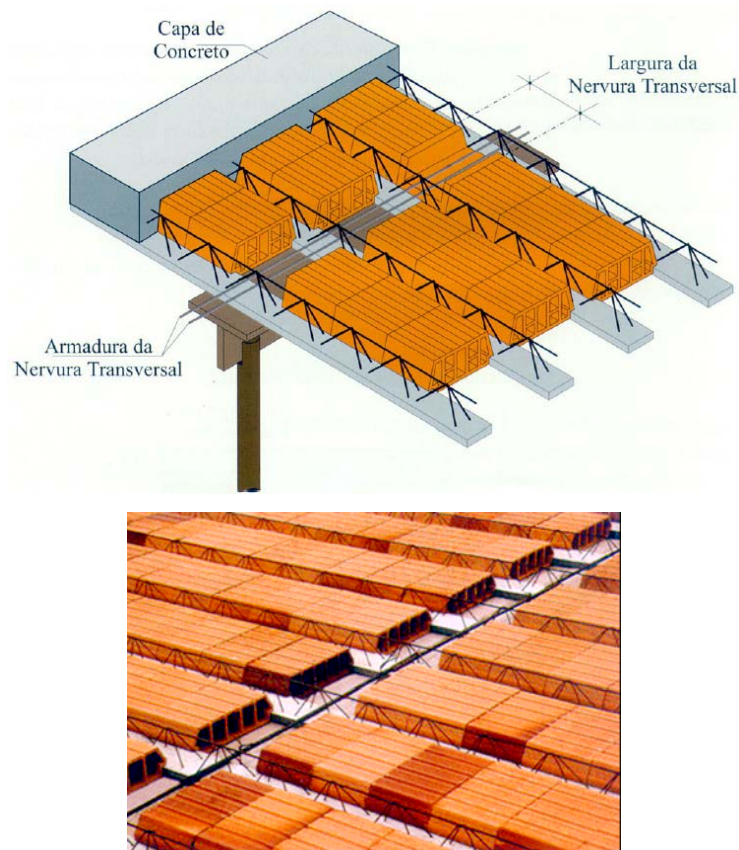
Nervura transversal de travamento (LAJES FAULIM, 1998).
